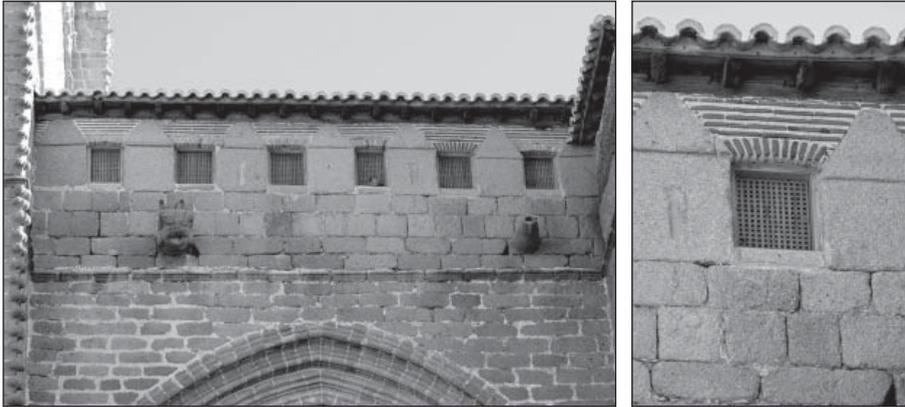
Fachada de la casa del campanero y detalle de la ventana tras la restauración.
